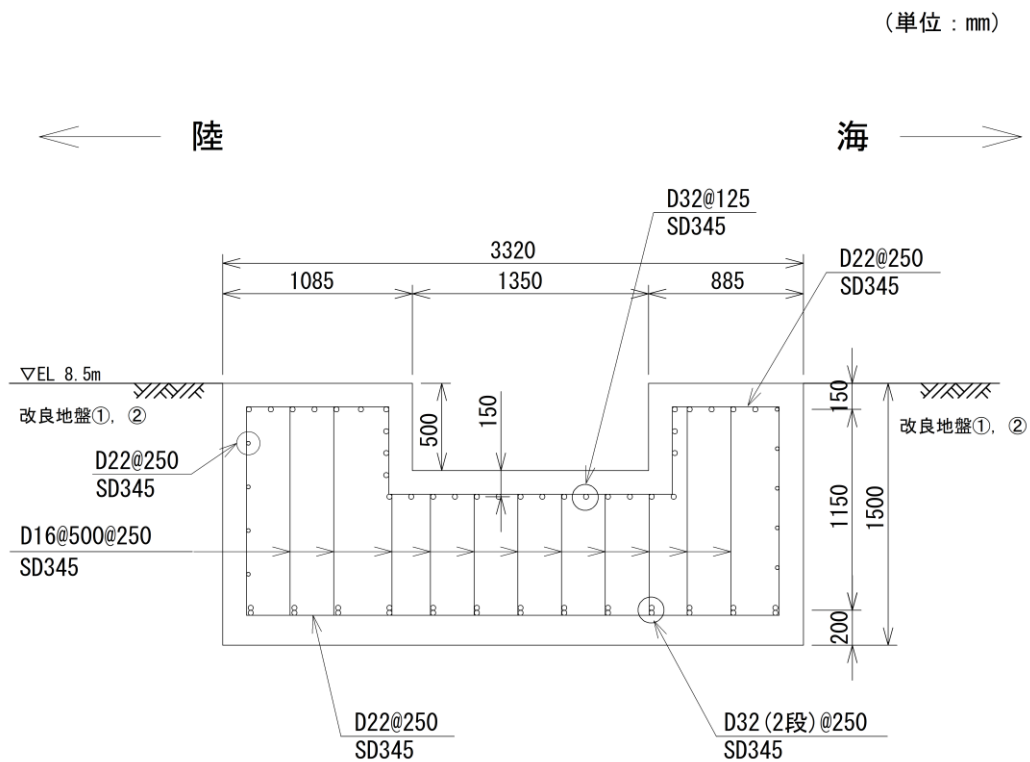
防波扉基礎スラブの概略配筋図 (B-B 断面)
